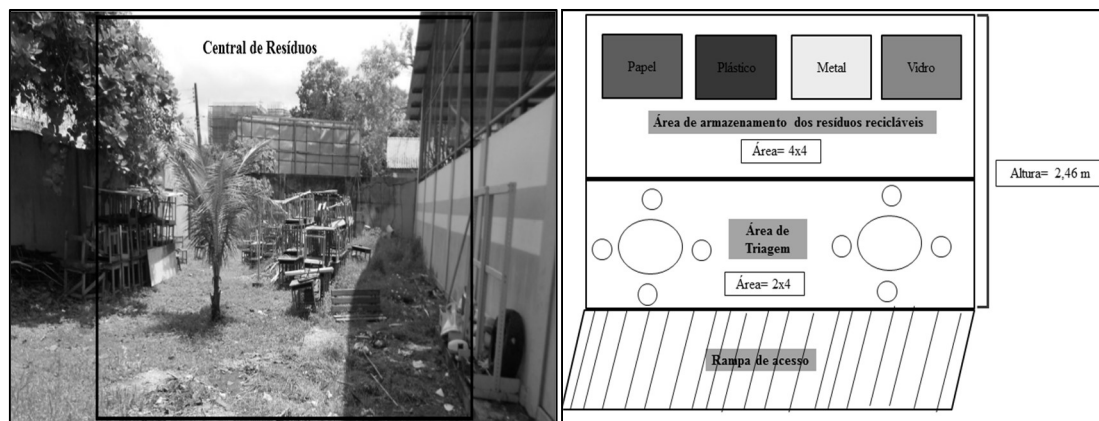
Local disponibilizado para construção da central de resíduos e layout do projeto.
